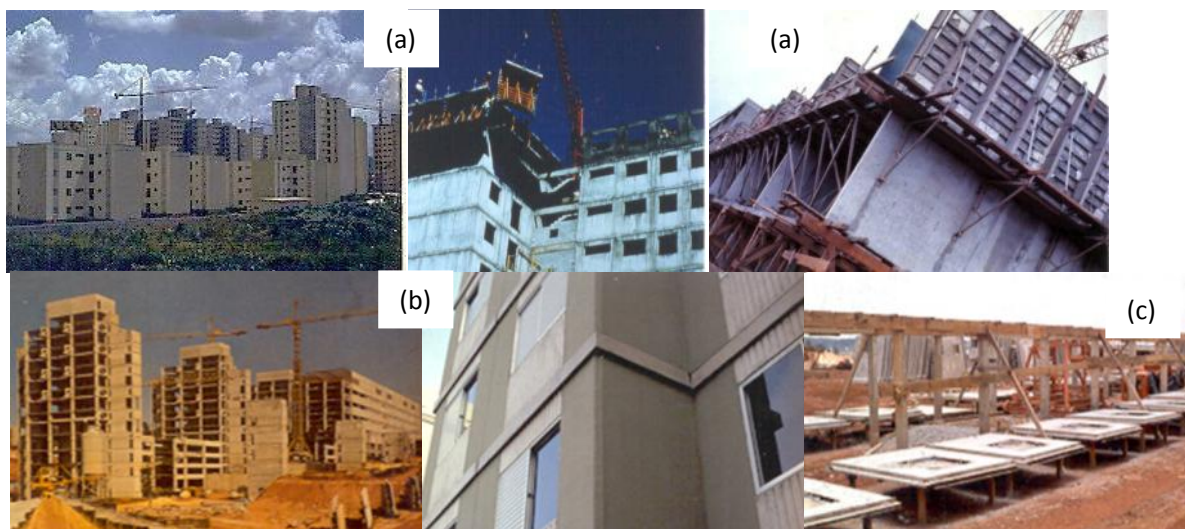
Conjuntos habitacionais de meados da década de 80 em São Paulo (a) Sistema de paredes maciças de concreto moldadas com fôrmas de aço - sistema *Outnord*; (b) edifício com painéis e lajes pré-fabricados de concreto (c) produção de painéis pré-fabricados de concreto em usina, para edifícios de múltiplos pavimentos (Fonte: Arquivo Mercia Bottura Barros).
